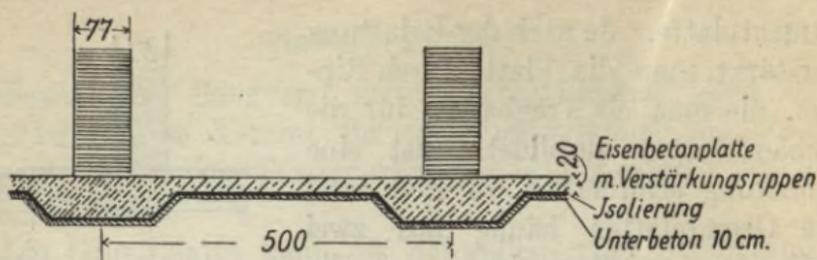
Eisenbetonrippenplatte mit Grundwasserabdichtung.
